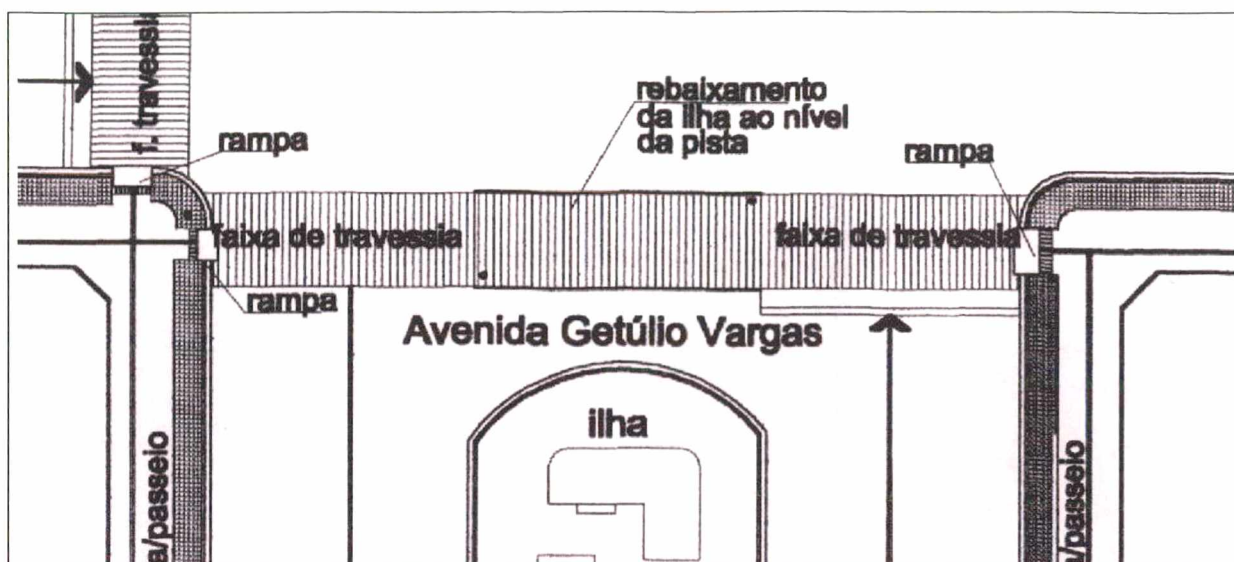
Planta baixa, com localização de rampas, faixa de travessia, rebaixamento da ilha central com guarda – corpos.
